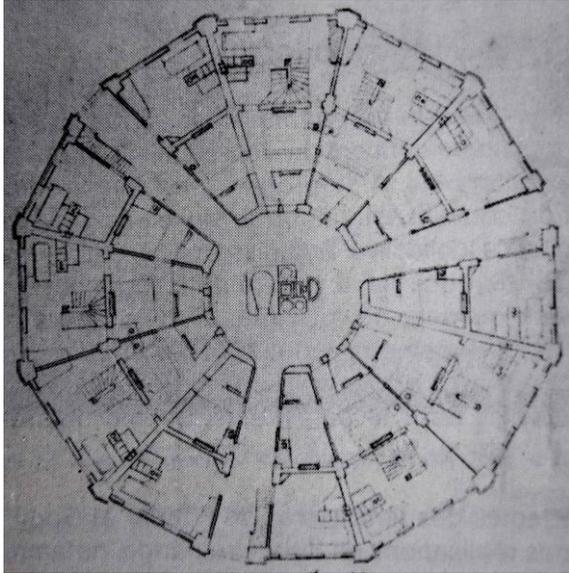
Plan du rez-de-chaussée du logement de Franz Bernhard Meyer
